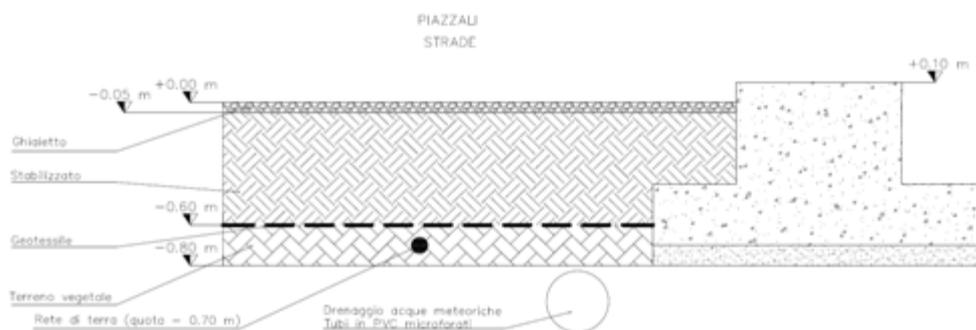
Sezione tipo piazzale e strada di circolazione all'interno della stazione elettrica
